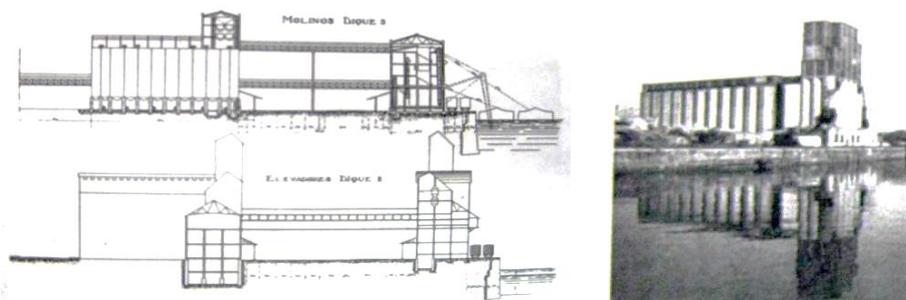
Elevadores de la Junta Nacional de Granos. Corte, vista, e imagen.
